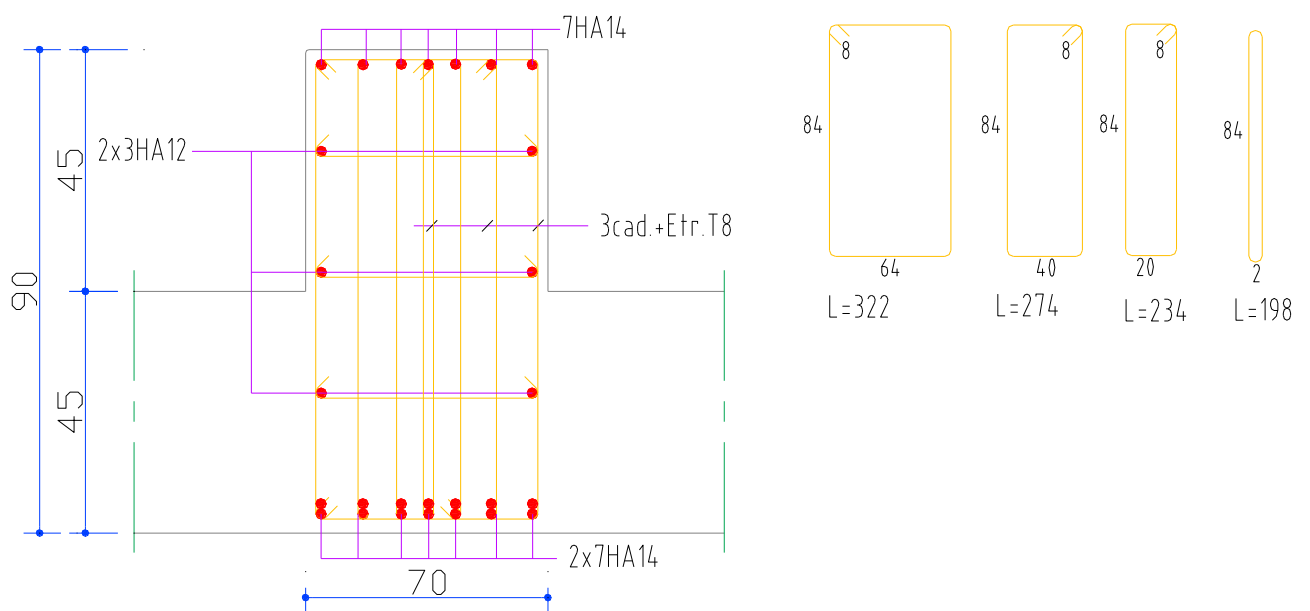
Coupe de ferrailage des nervures secondaires au niveau appuis.
